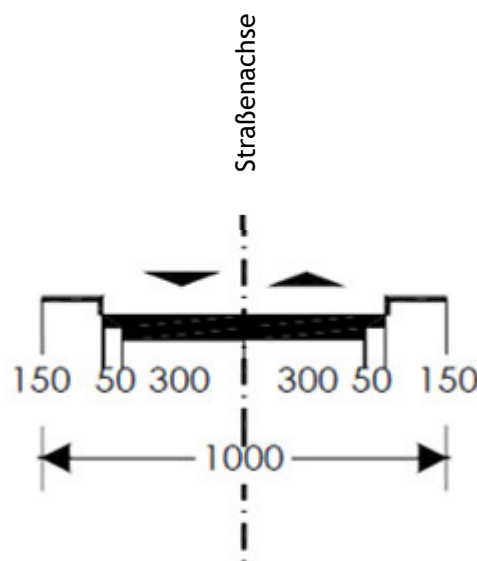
Typisches Querschnittsprofil einer Stadtviertel-Verbindungsstraße
